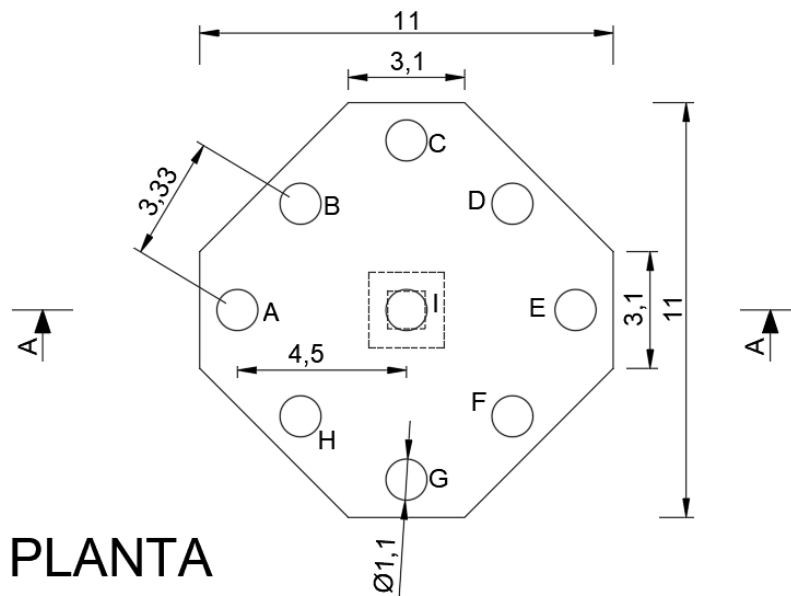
Disposición en planta de los pilotes usados para fundar las pilas del puente.
